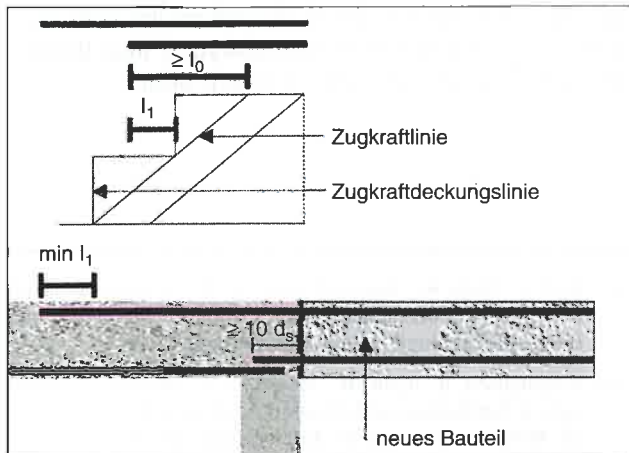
Anschluss einer Platte ohne Anschlussbewehrung im bestehenden Bauteil
